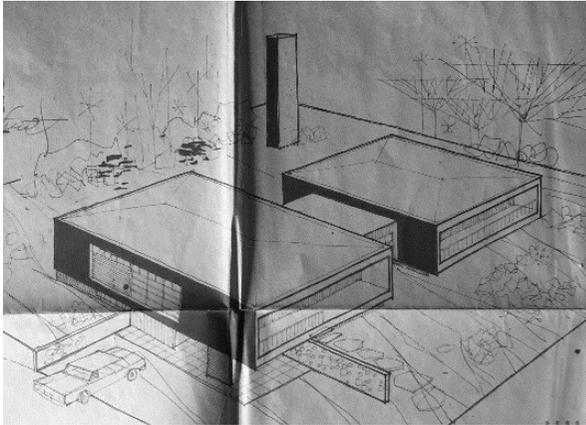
Croqui do projeto de Tertuliano Dionísio.
